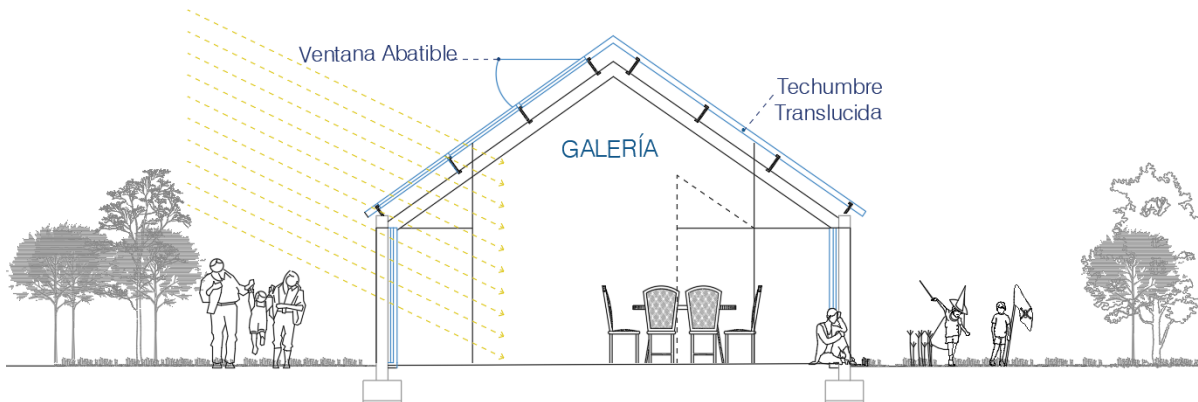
Cortes esquemáticos casa en Dordña. Fuente: Elaboración Propia
